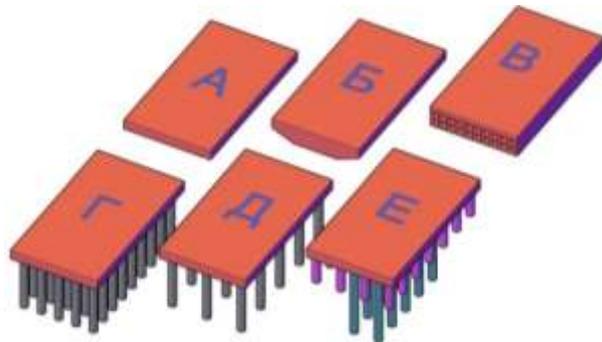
Конструктивные типы фундаментов высотных зданий:
